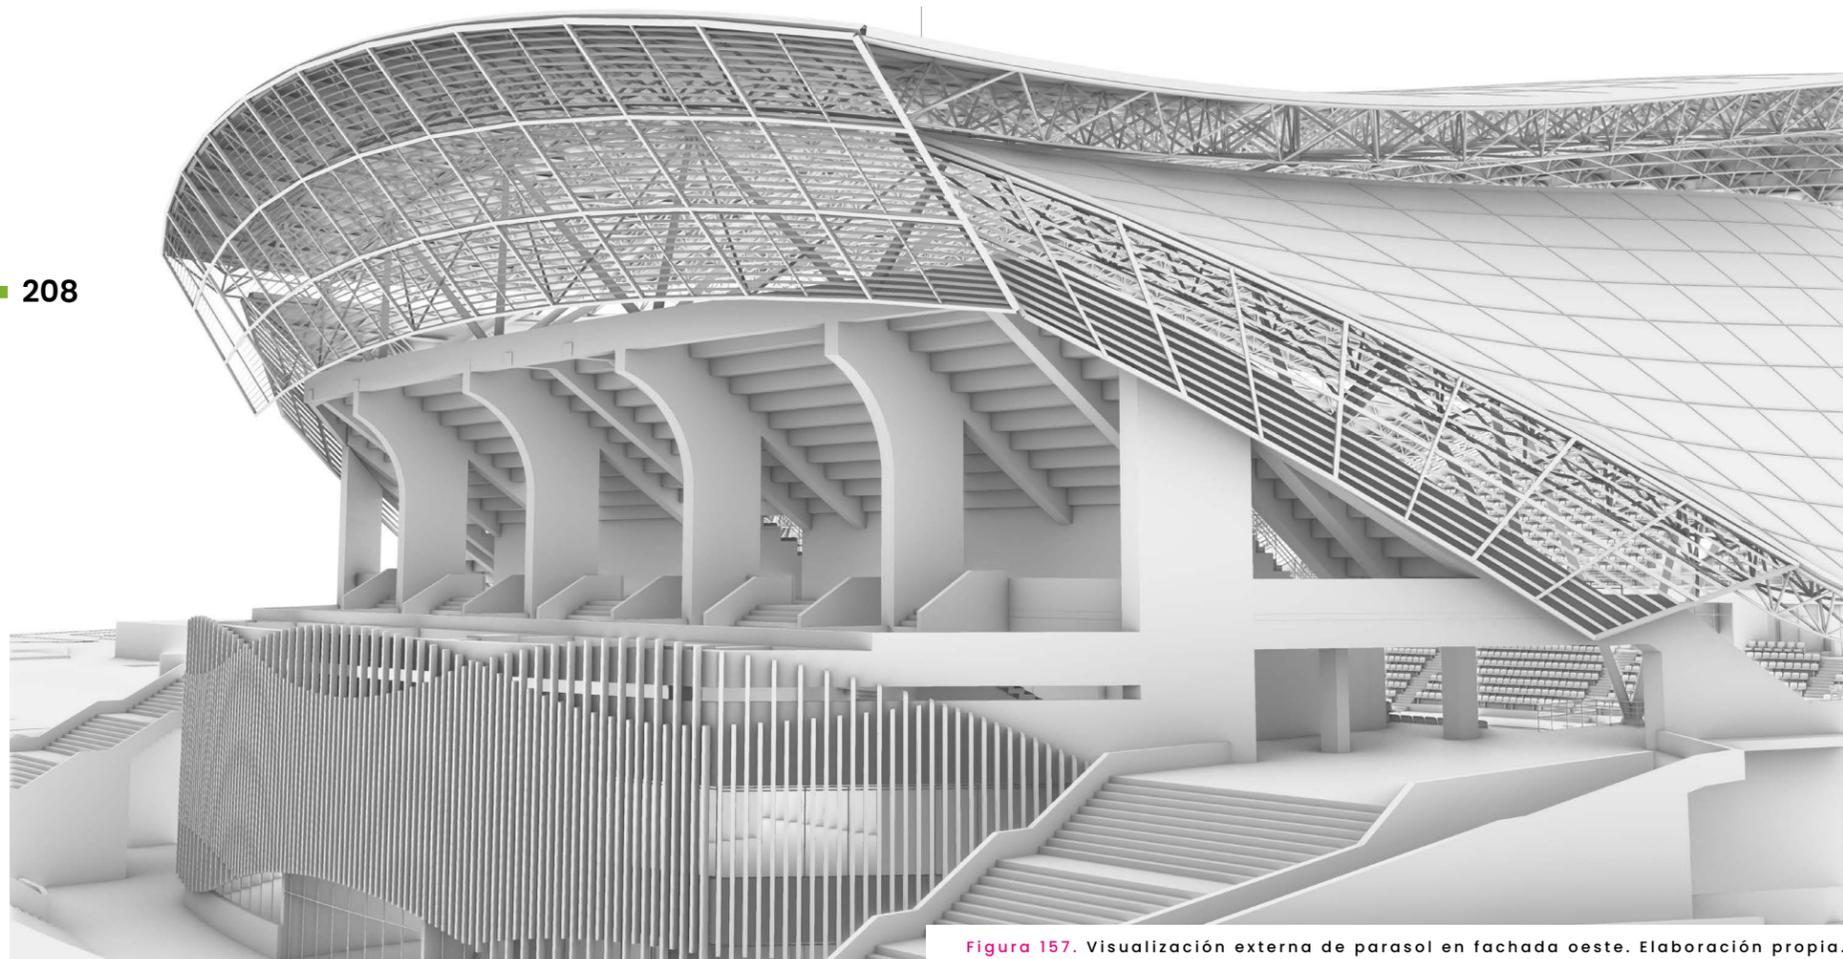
Visualización externa de parasol en fachada oeste. Elaboración propia.
